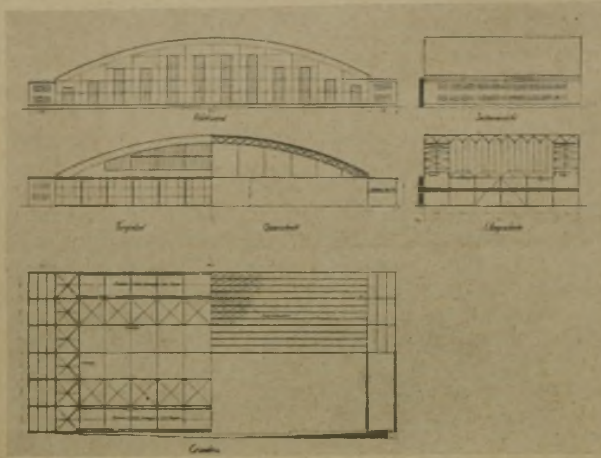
OLA-Leichtbauhalle mit seitlichen Anbauten; oben links: Rückwand, rechts: Seilenansicht, Mitte links: Torgiebel und Querschnitt, rechts: Längsschnitt, unten: Grundriß
